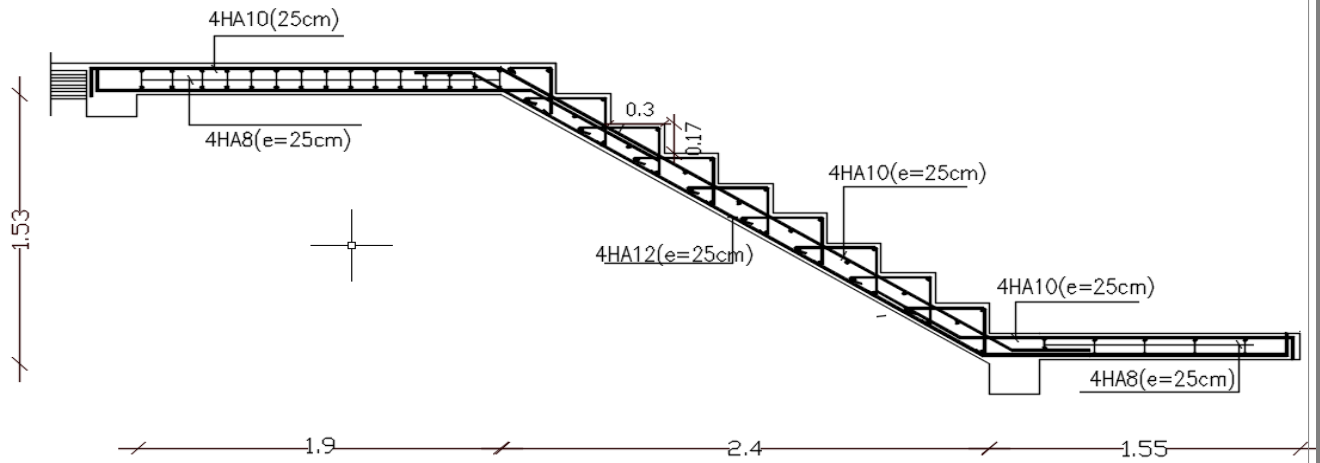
calcul Plan de ferrailage de l'escalier.
